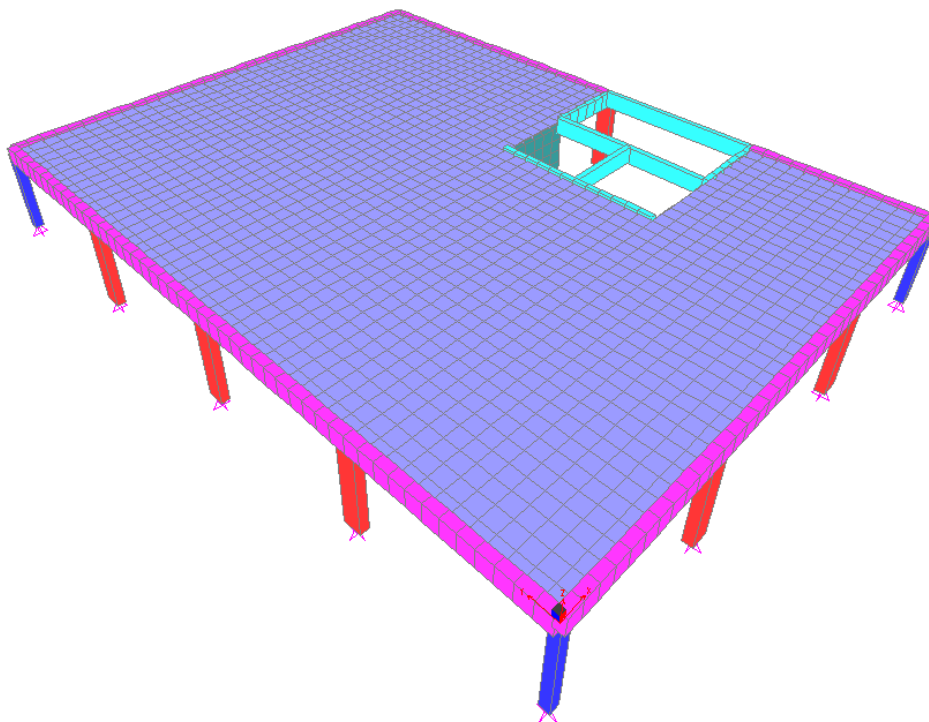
Estrutura do pavimento tipo em 3D via SAP2000
